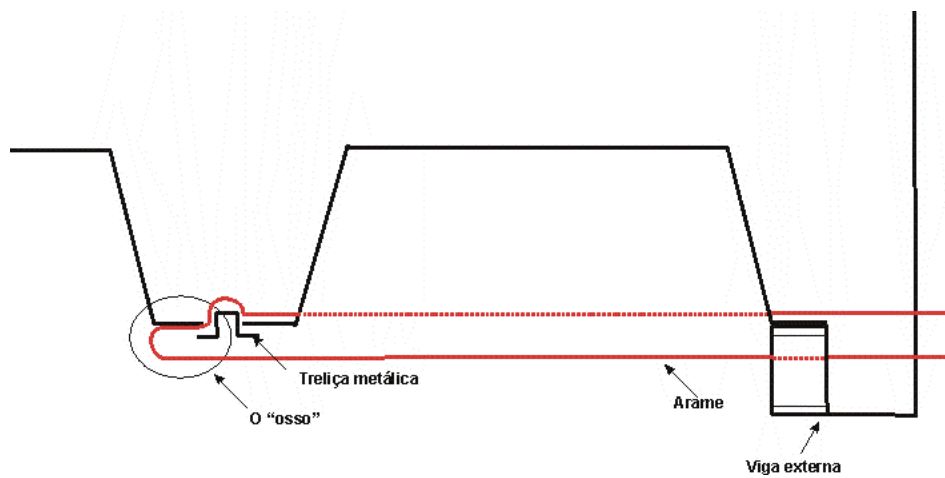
Detalhe do arame passando pelo local de fixação da forma pré-fabricada na estrutura metálica - o "osso". Belo Horizonte, 2007
